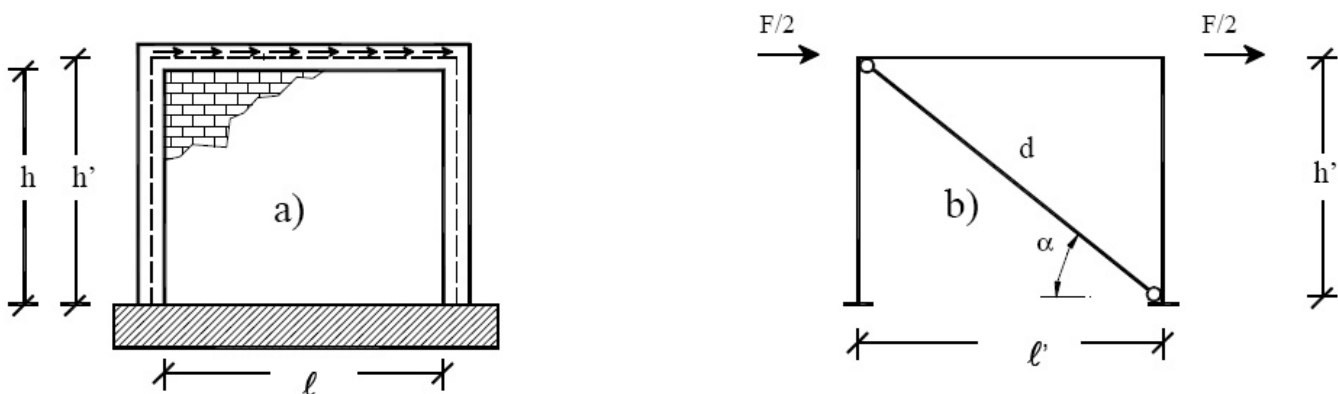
Schema strutturale e modello di calcolo semplificato
